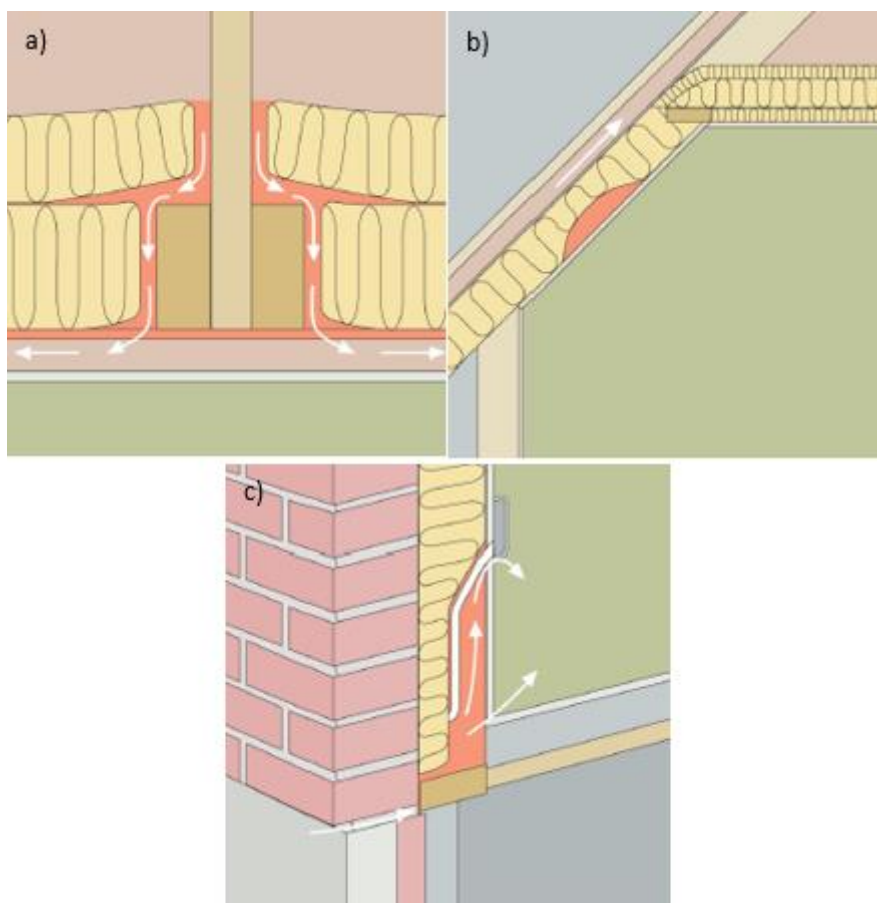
a) Incorreta colocação de isolamento sobre a viga do pavimento b) Incorreta colocação do isolamento, originando uma bolsa de ar no lado exterior do teto inclinado c) Colocação incorreta de placas de isolamento na presença de uma rede de alimentação elétrica (FLIR 2010).
